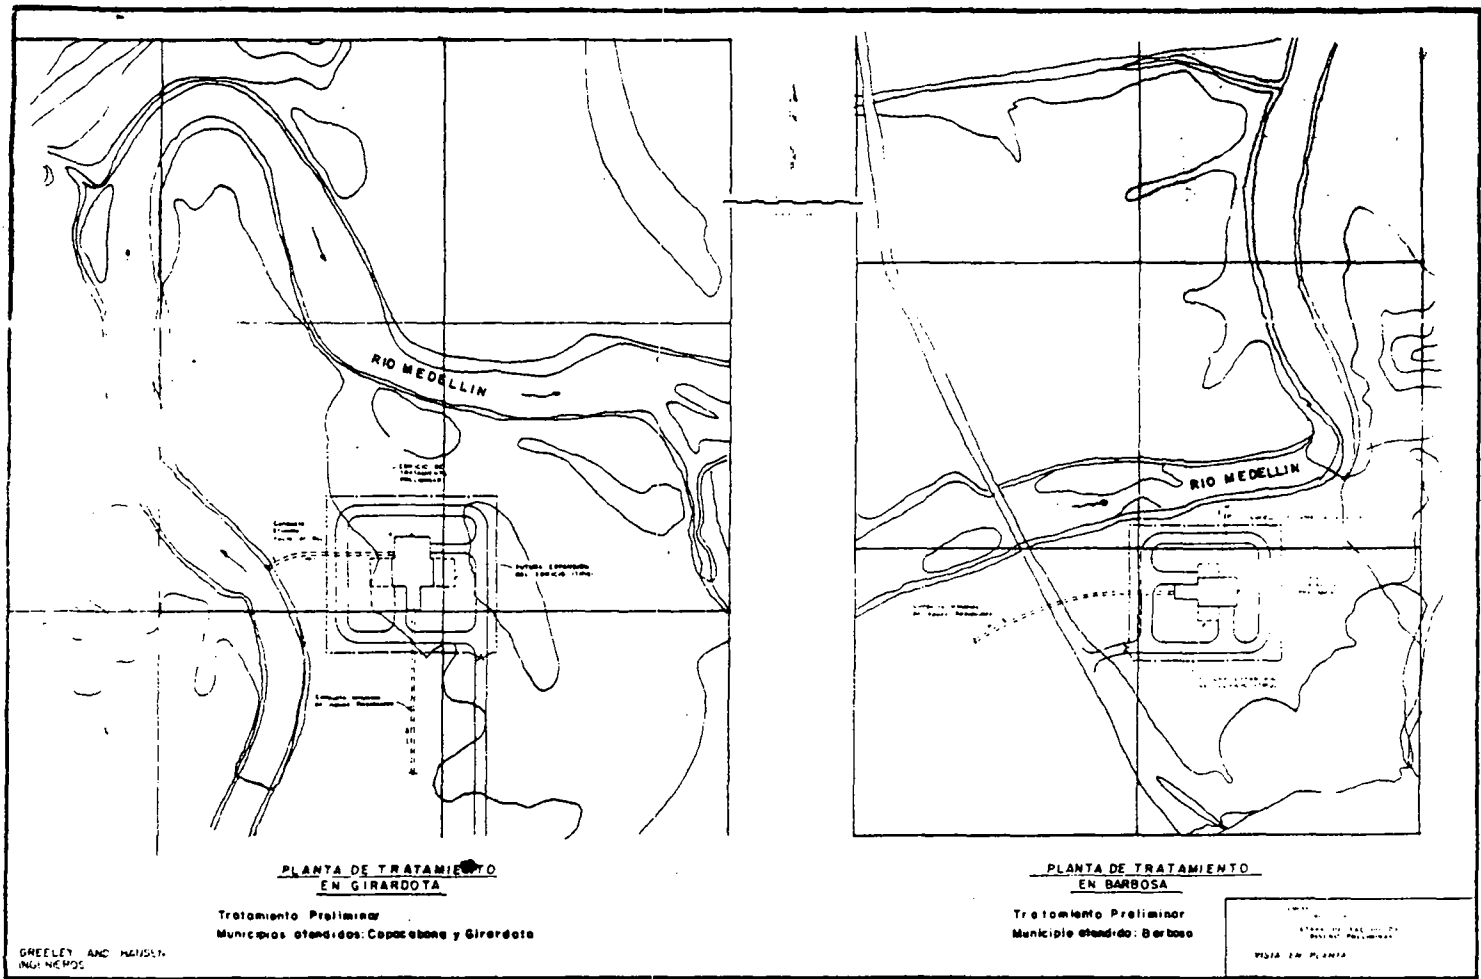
Plantas de tratamiento de Aguas Residuales en Girardota y Barbosa
